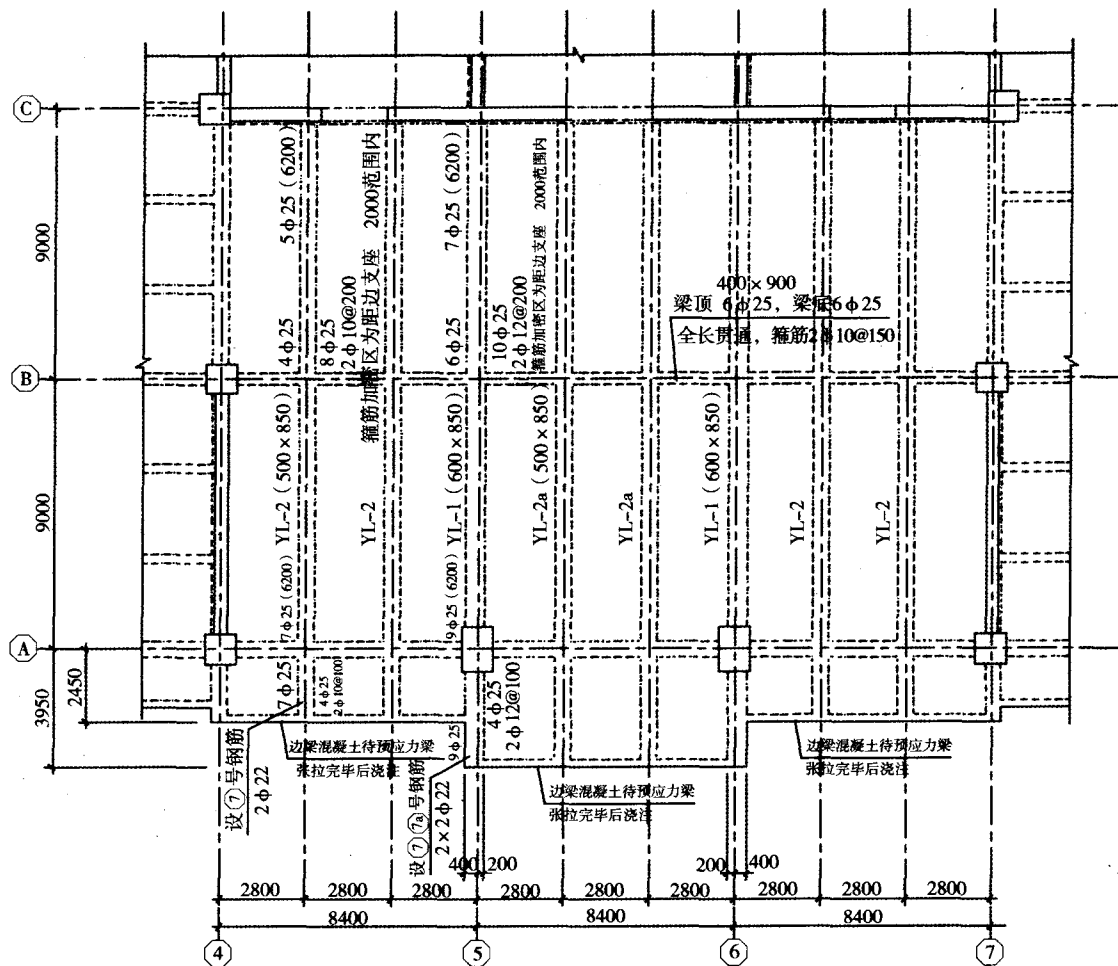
标高22.100m层预应力梁平面布置及非预应力钢筋配置图
